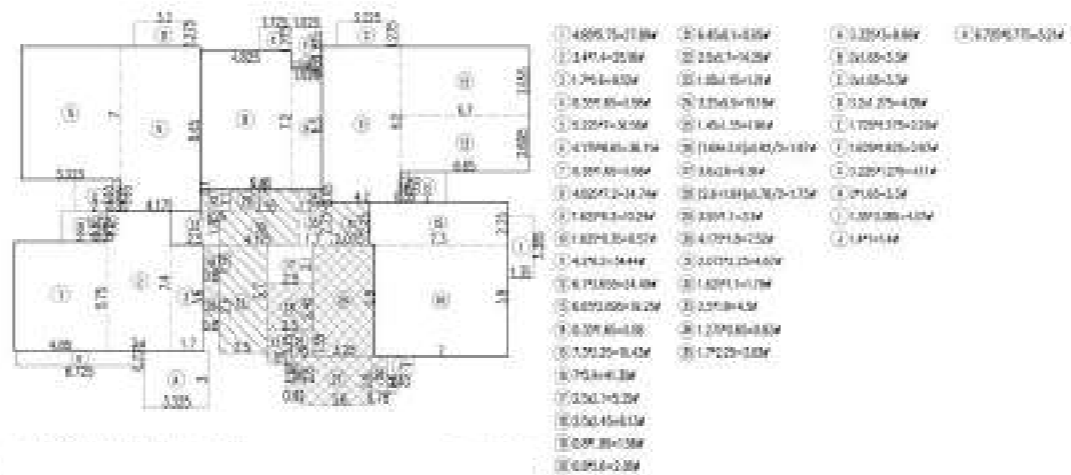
地上 3 層平面圖 (比例尺 1/200)
